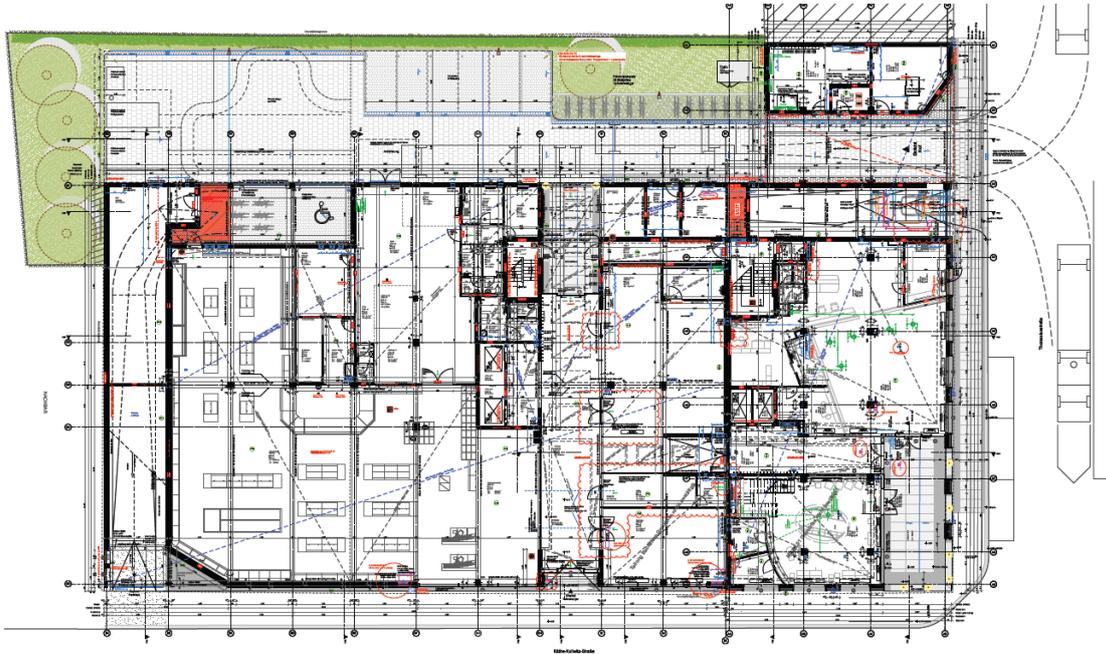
Ausschnitt aus Grundriss EG / Lageplan
